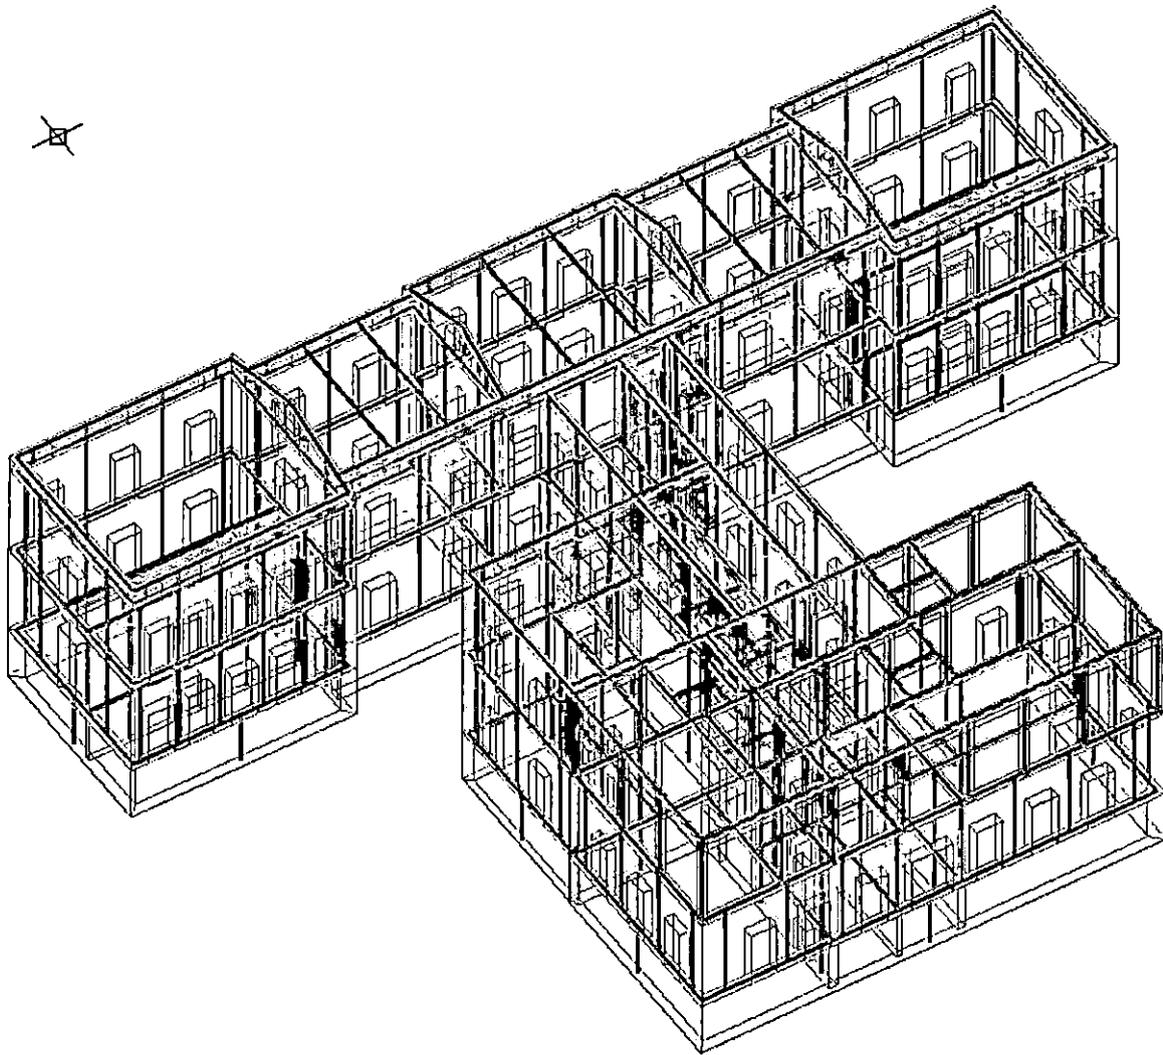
Vista 3D – Modello struttura in muratura in PCM- Anteprima modellazione a telaio equivalente.
